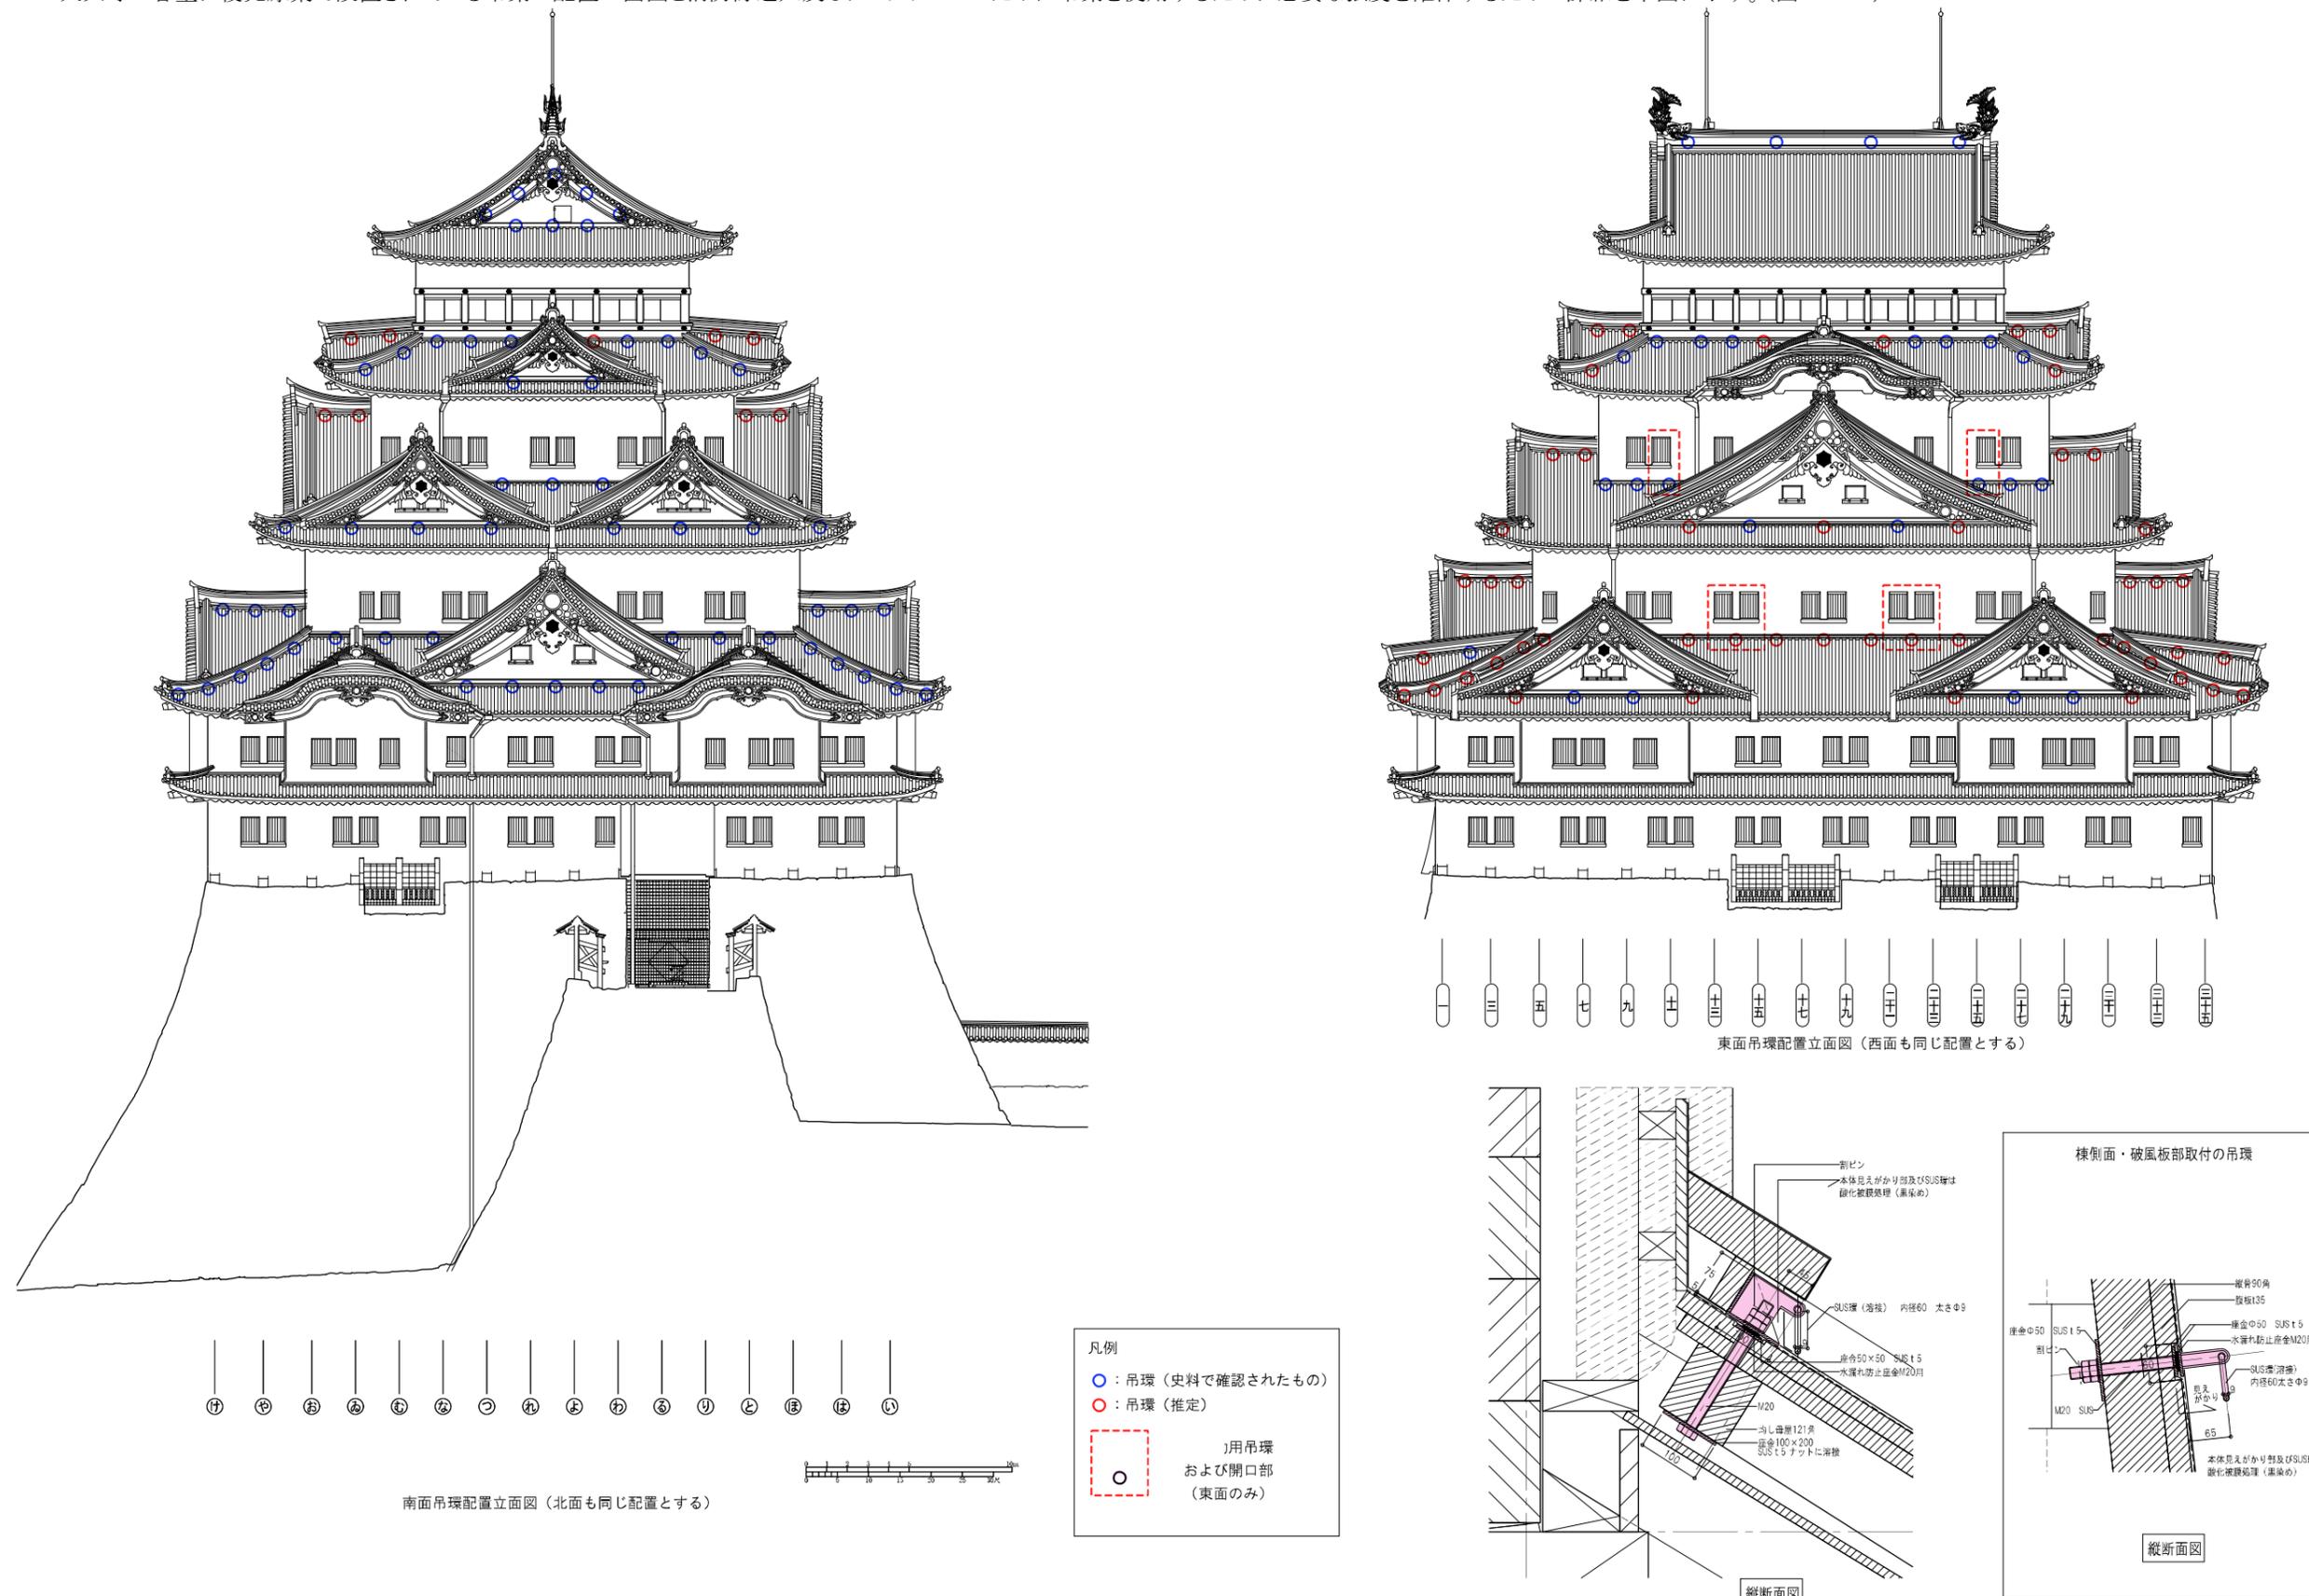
大天守屋根の吊環配置立面図 及び 吊環詳細図
